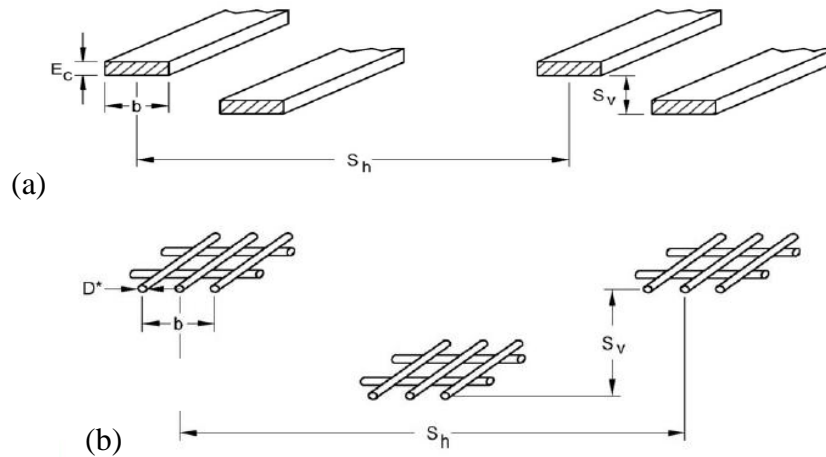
Espaciado de los refuerzos utilizados en los muros mecánicamente estabilizados (a) tiras metálicas y (b) mallas de barra (FHWA, 2009)
